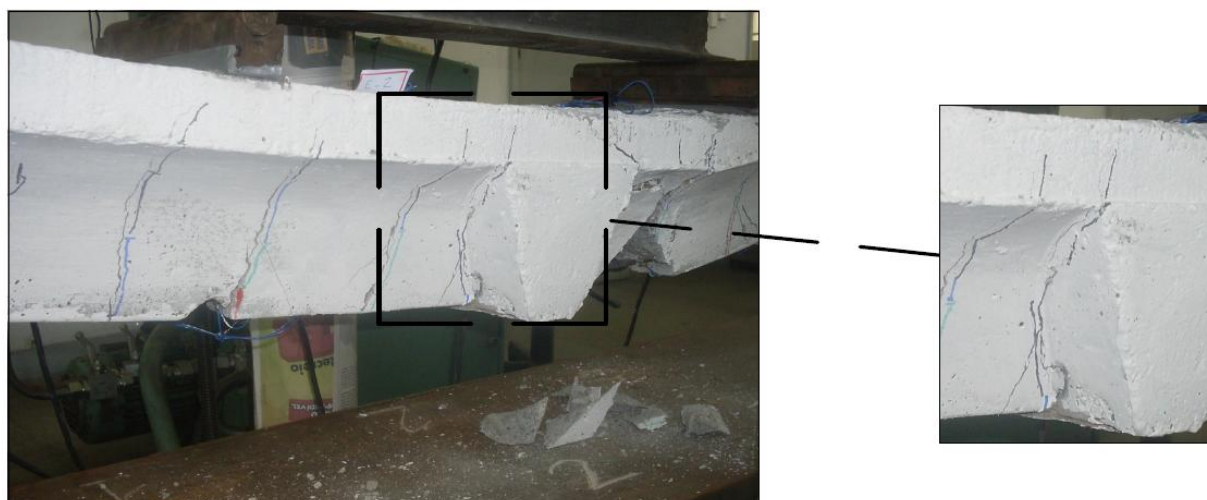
Detalhe do esmagamento do concreto de V-2B
